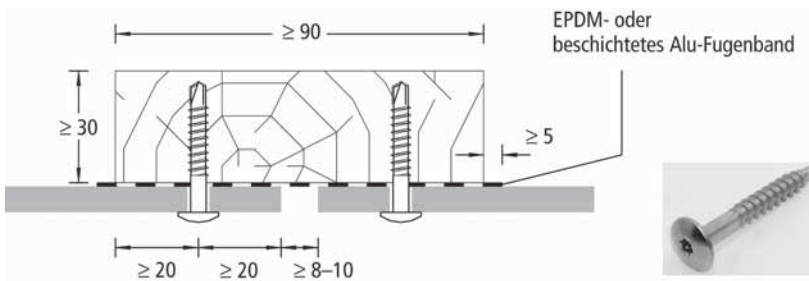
Befestigung an der Holz-Unterkonstruktion durch eine farbige Fassadenschraube
